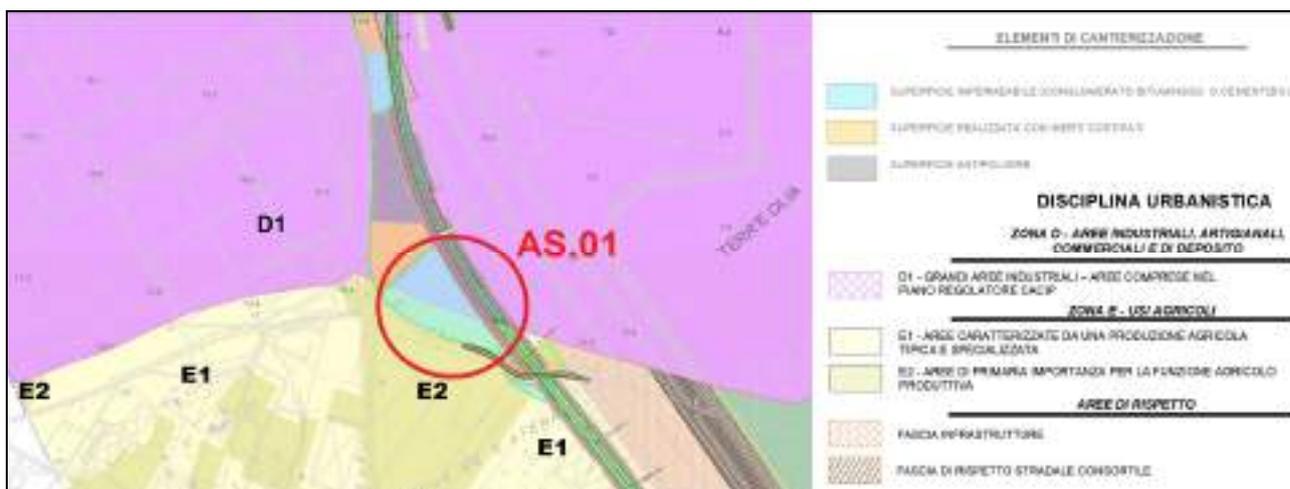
Sovrapposizione del tracciato e delle aree di cantiere operativo-stoccaggio sulla perimetrazione urbanistica – Area di stoccaggio AS.01.
